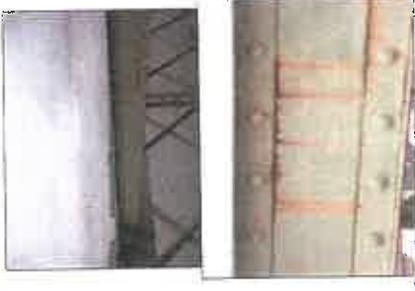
Fissure dans le congé de la cornière verticale/ assemblage PP107 et poutre latérale D, longueur de la fissure 220 mm.
